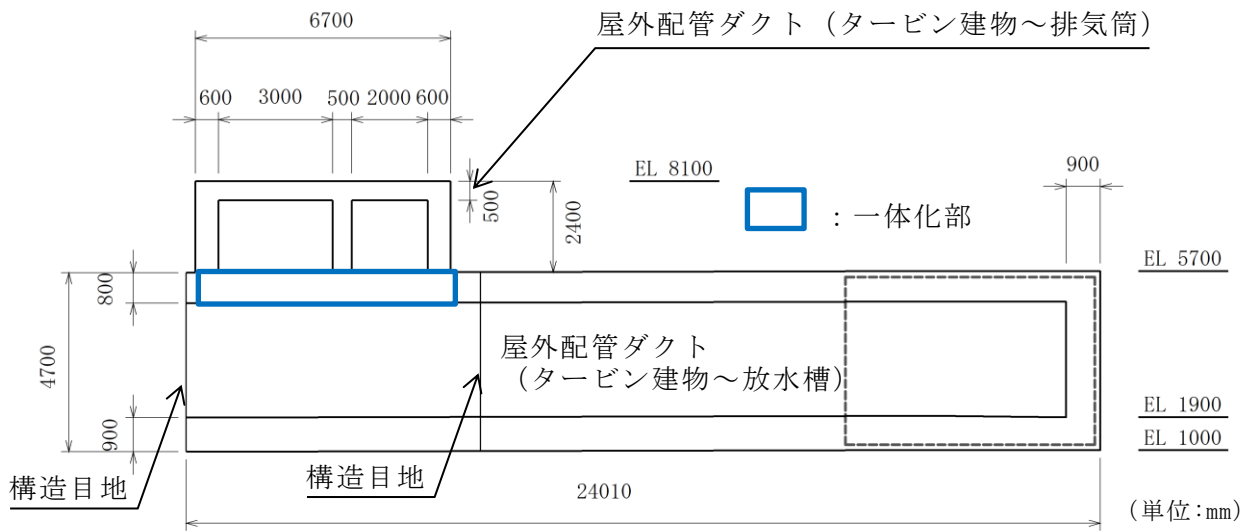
屋外配管ダクト (タービン建物～排気筒) 断面図 (B-B 断面)
